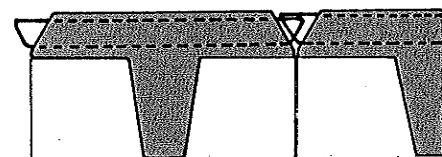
Éléments de plancher en forme de T et clavetage entre éléments.
